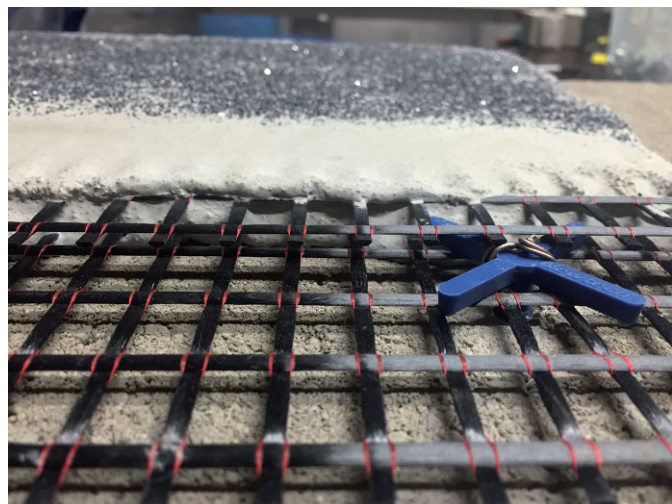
KKS-Textilbeton; Applikation im Laminierverfahren
